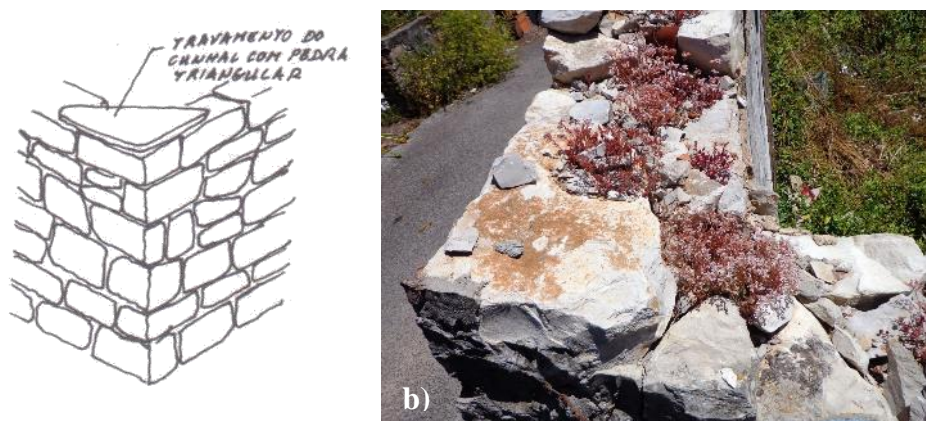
a) e b) Utilização de pedra triangular estabilizante
